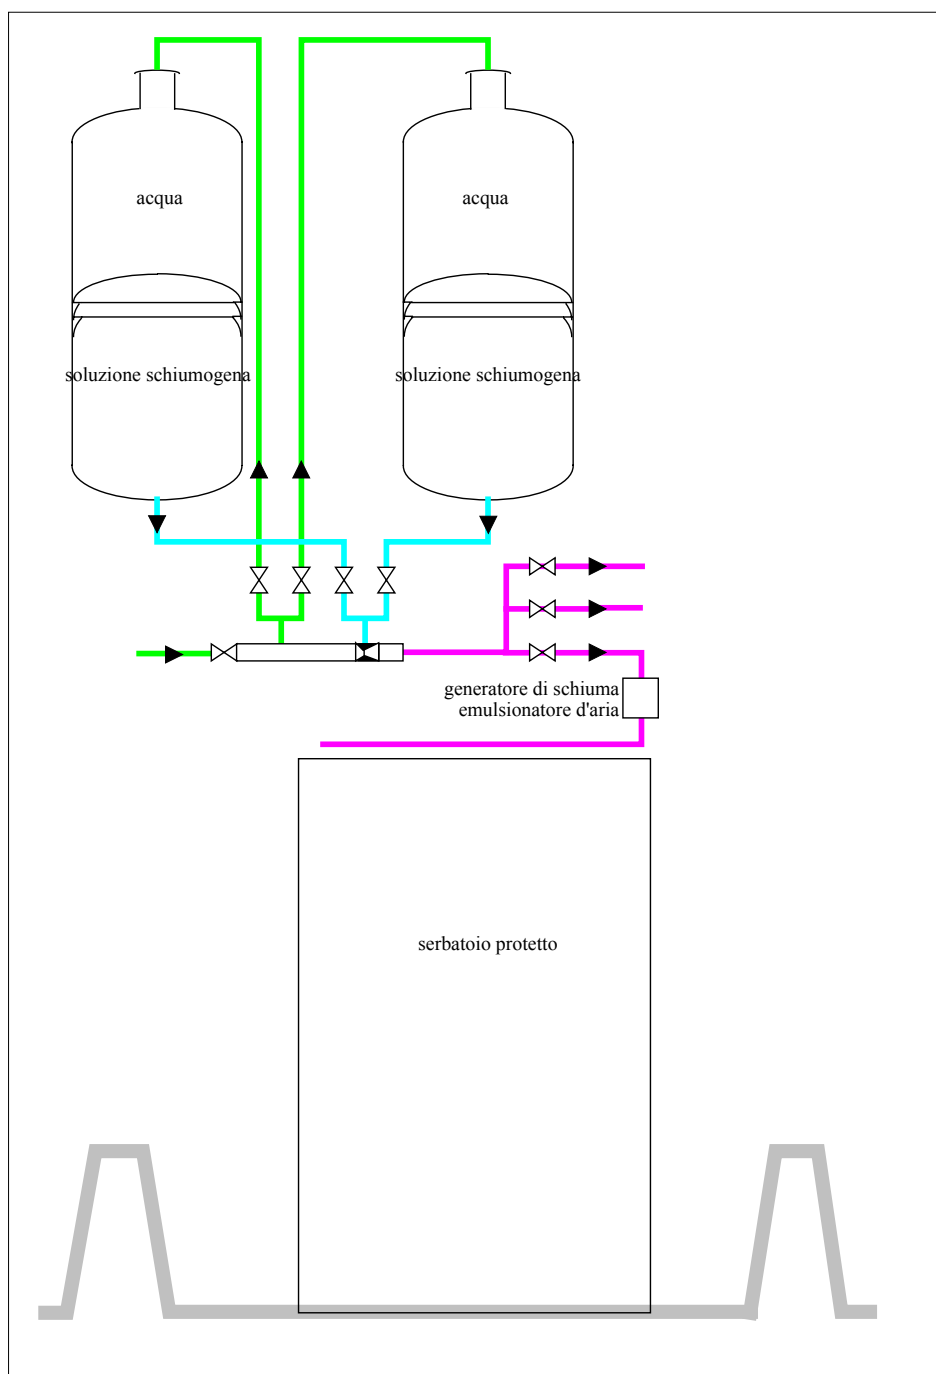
Schema dell'impianto fisso di preparazione della miscela schiumogena, a protezione di un serbatoio di stoccaggio di infiammabili.
